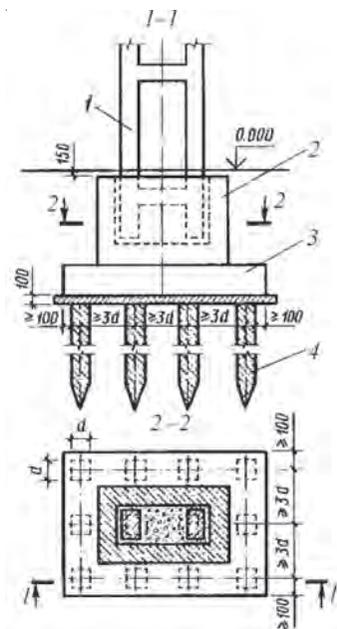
Конструкция фундамента с применением буронабивных свай: 1 – колонна; 2 – подколонник стаканного типа; 3 – бетонная подушка; 4 – буронабивная свая
